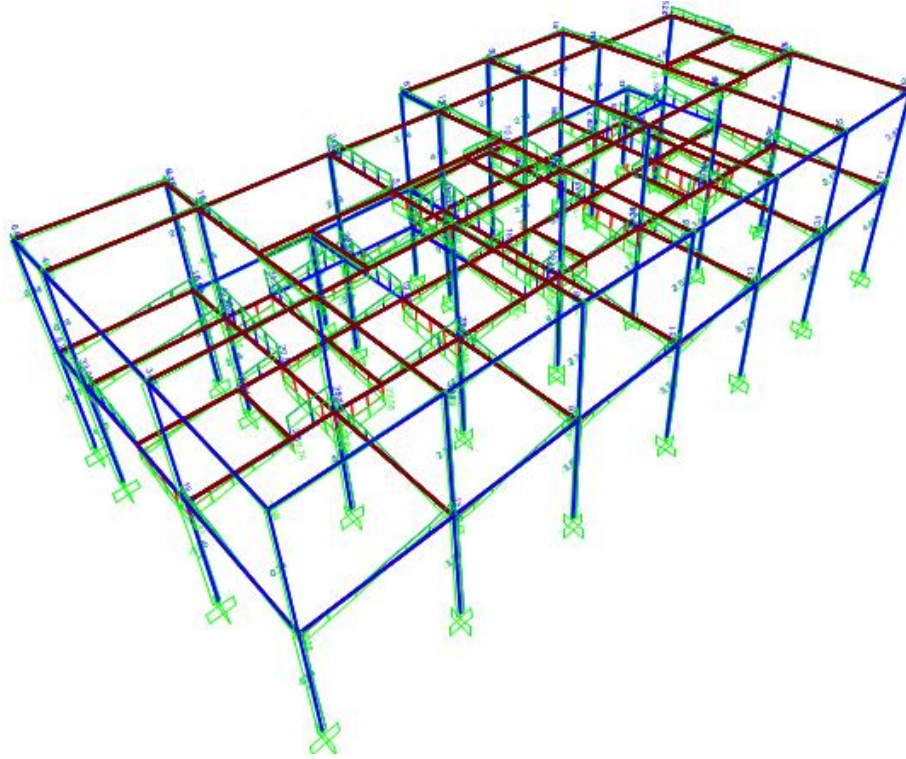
Desplazamiento máximo entrepiso y cubierta según SAP2000
